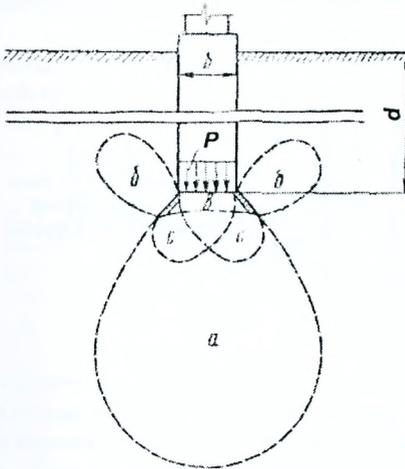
Схема к приближенному определению осадки фундамента глубокого заложения в общем случае с учетом возникновения областей предельного состояния
